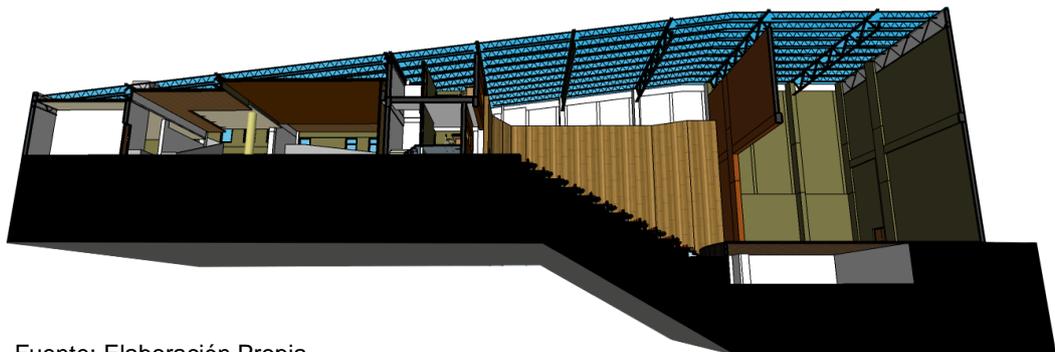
Distribución de Cargas Estructurales de las Vigas Joist y Girder
